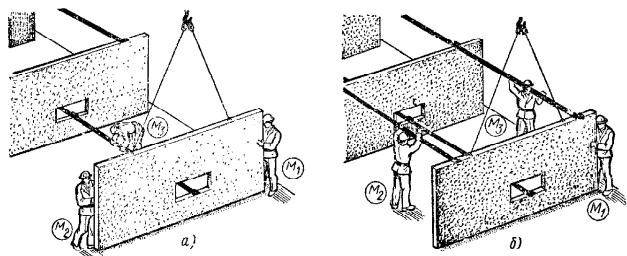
Монтаж поперечных несущих стен подземной части здания:
